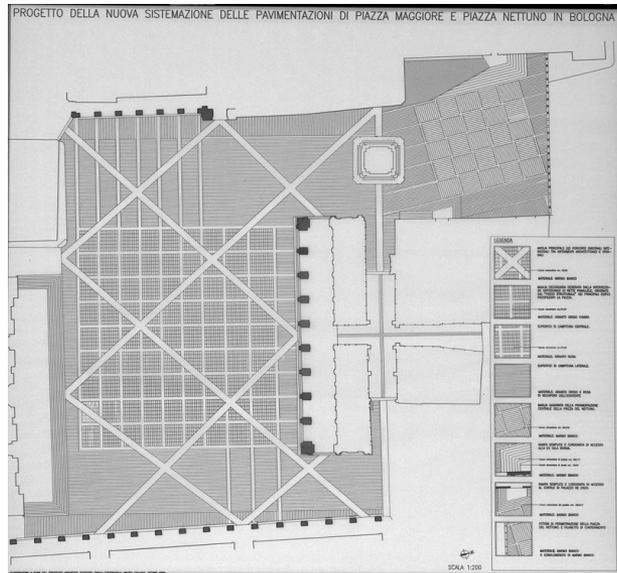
Pavimentazione Piazza Maggiore (disegno bn, rif. 195_8326 - Archivio Progetti riproduzione vietata diritti riservati).
